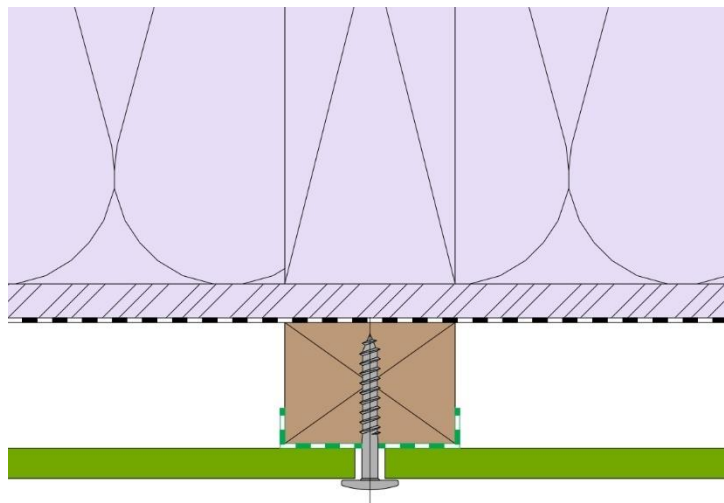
Exemple de point dilatant – fixation par vis sur tasseau – coupe horizontale
